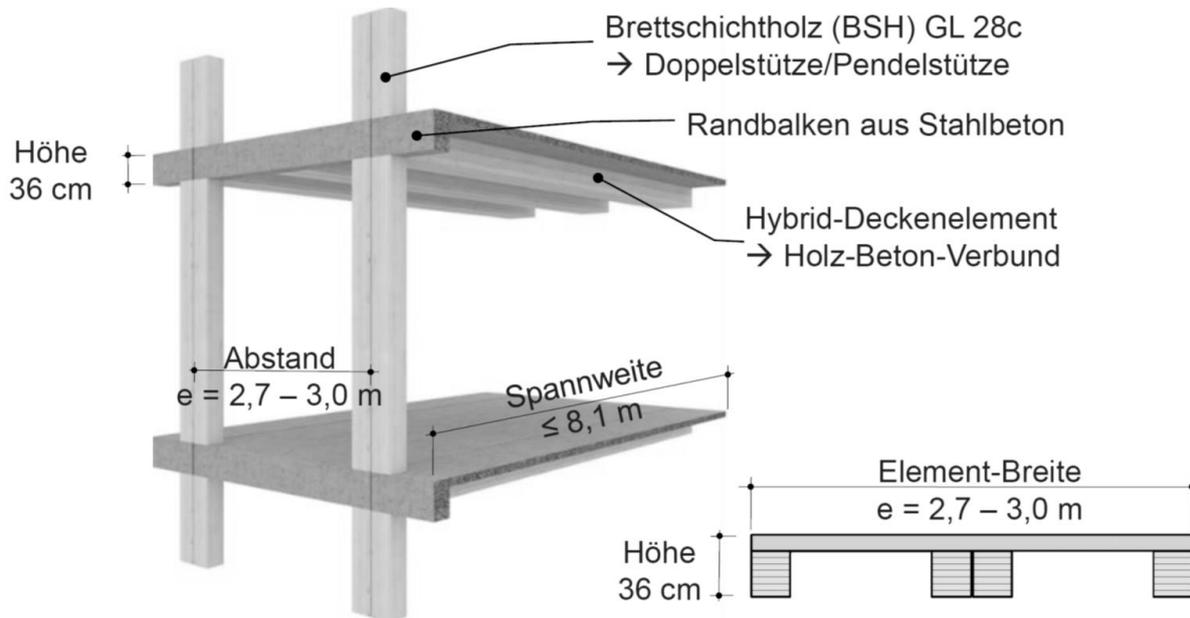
Darstellung des patentierten CREE Building System | © cree GmbH
